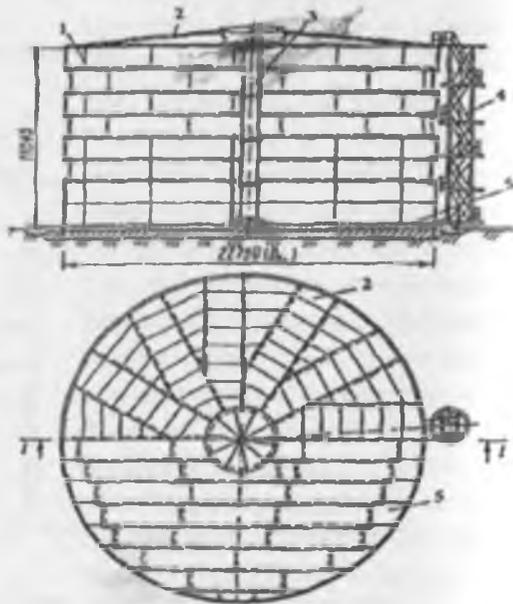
Вертикальный цилиндрический резервуар объемом 5000 м³ со щитовой кровлей: 1 – корпус; 2 – щитовая кровля; 3 – центральная стойка; 4 – шахтная лестница; 5 – днище
